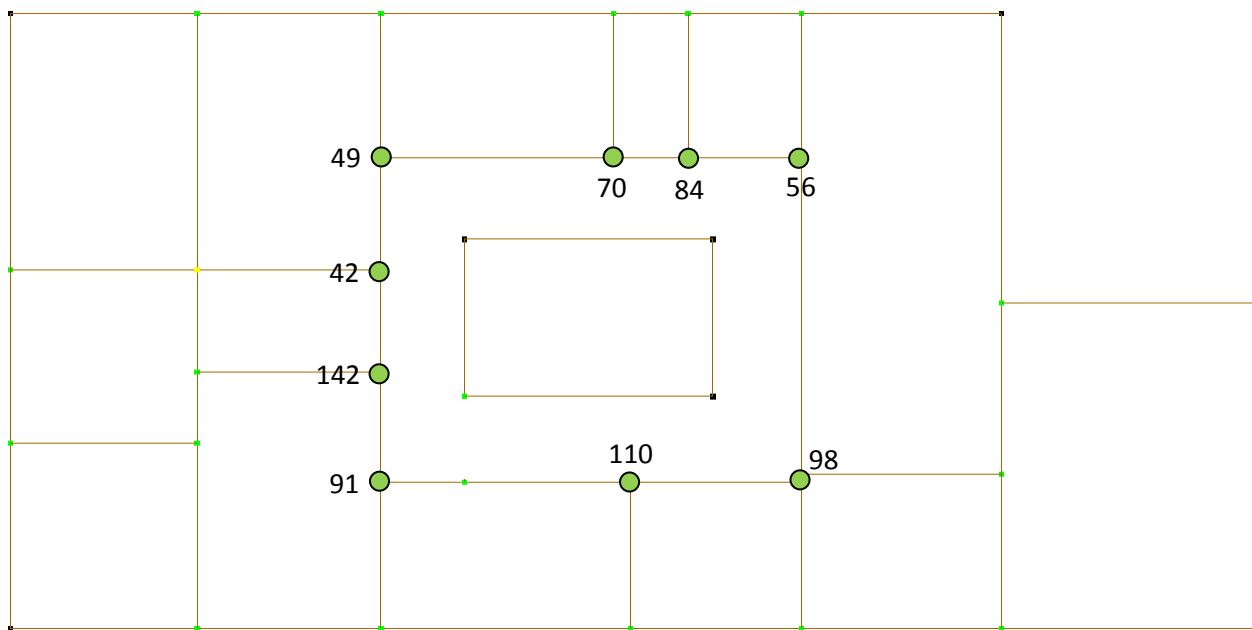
Pianta piano terra, con numerazione e individuazione dei nodi utilizzati nell'analisi
